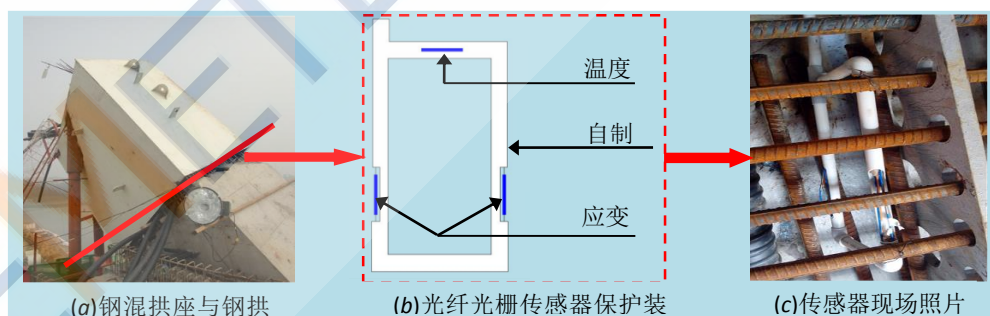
钢筋混凝土结合部位的传感器安装布置示意图
